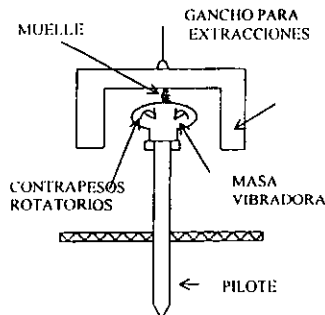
PILOTE HINCADO CON VIBRACIÓN
